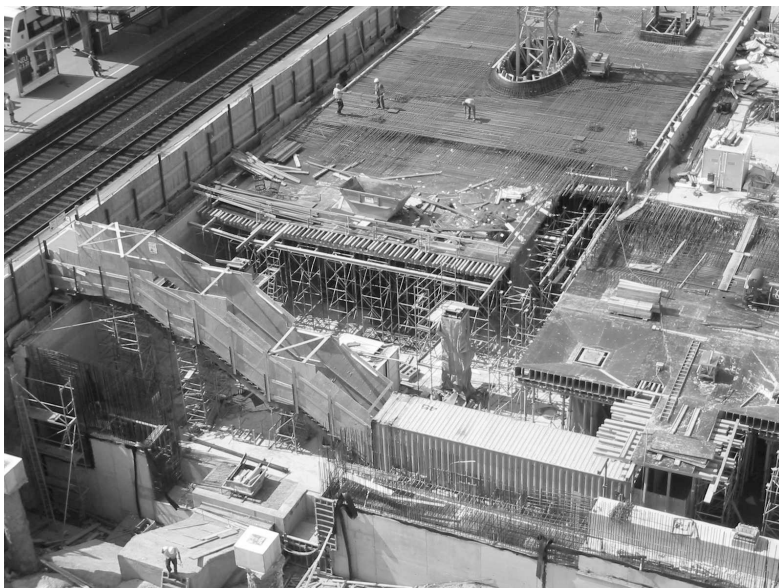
Das Bahnhofsgebäude (eigentlich Brückenbauwerk) wird erstellt
